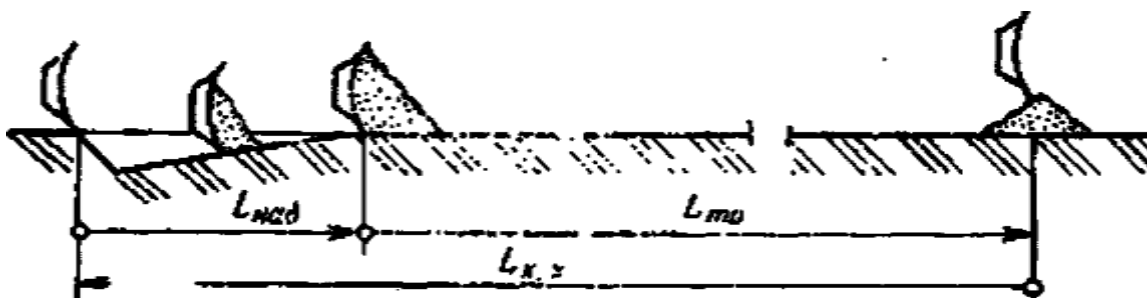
Элементы рабочего цикла разработки и перемещения грунта бульдозером:
